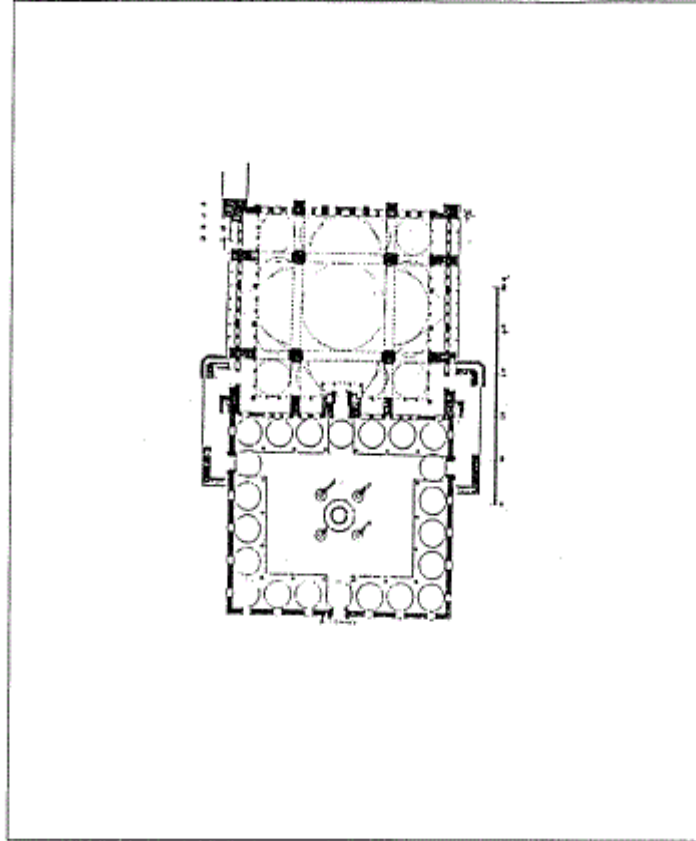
مسقط أفقي لمجمع شاهزاده في إستانبول (عن : اصلان ابا) .
